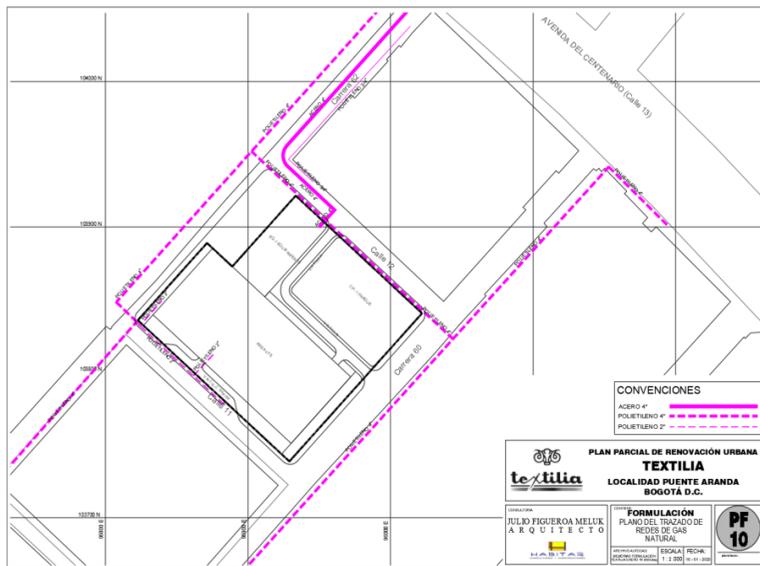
Plano PF-10 Trazado de Redes de Gas Natural
